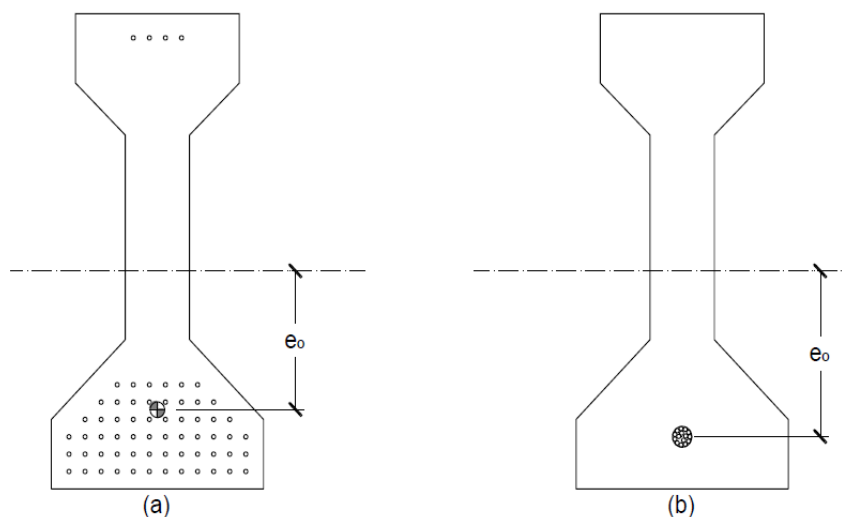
Cables resultantes en vigas pretensadas y postensadas
